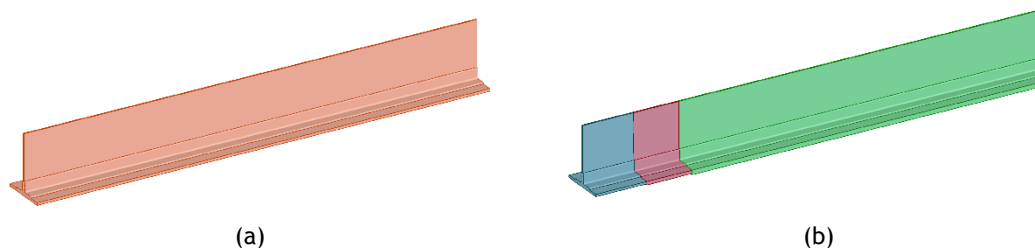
(a) Banzo inferior composto por uma secção transversal; (b) Banzo inferior composto por três secções transversais
